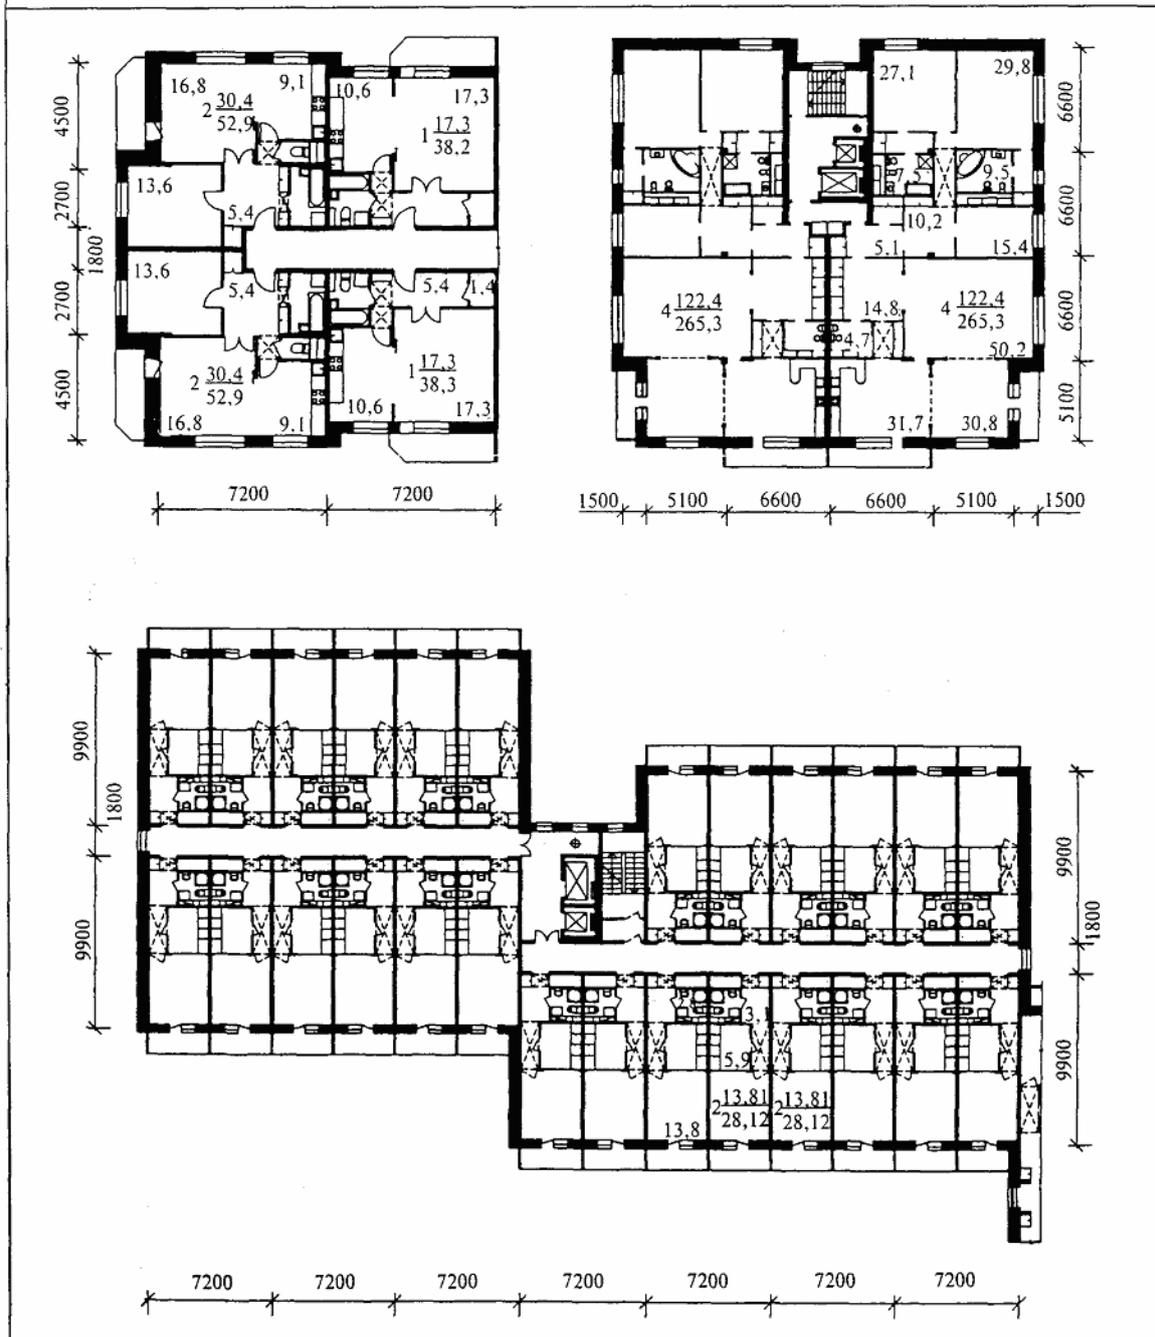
Энергосберегающие объемно-планировочные решения жилых зданий
